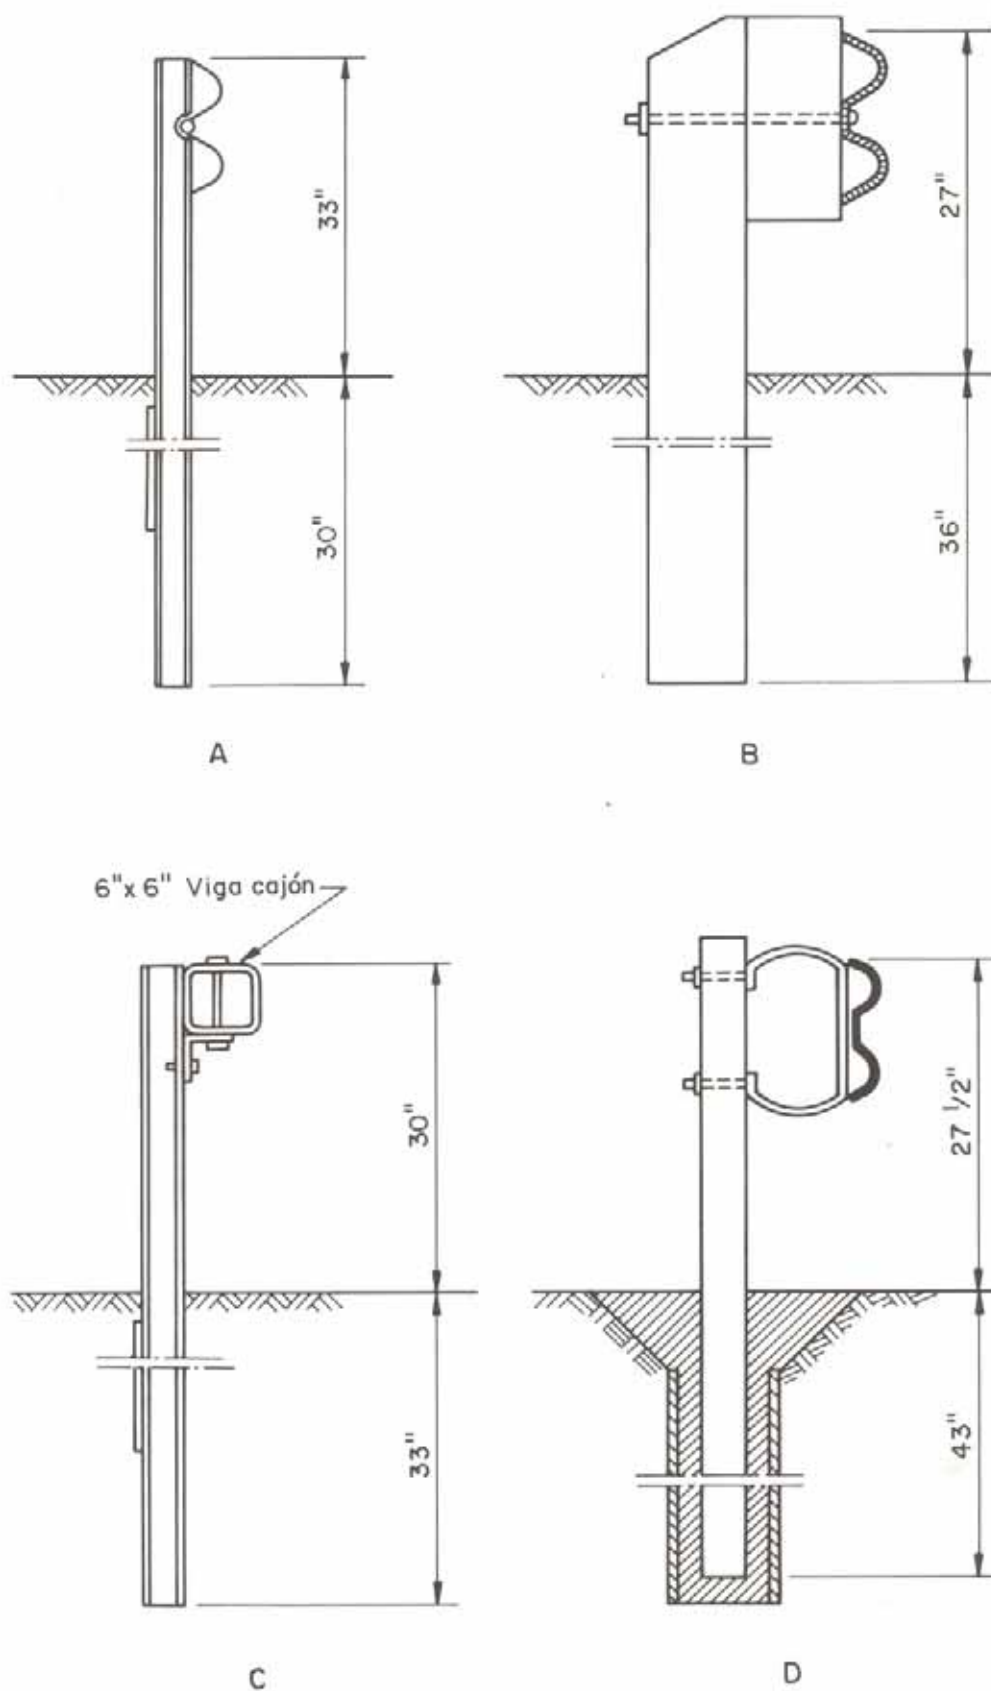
Diversos tipos de defensas semi-rigidas. a. Viga W sobre poste débil. b. Defensa con viga W saliente. c. Defensa con viga-cajón. d. Defensa con viga W montada en resorte.
